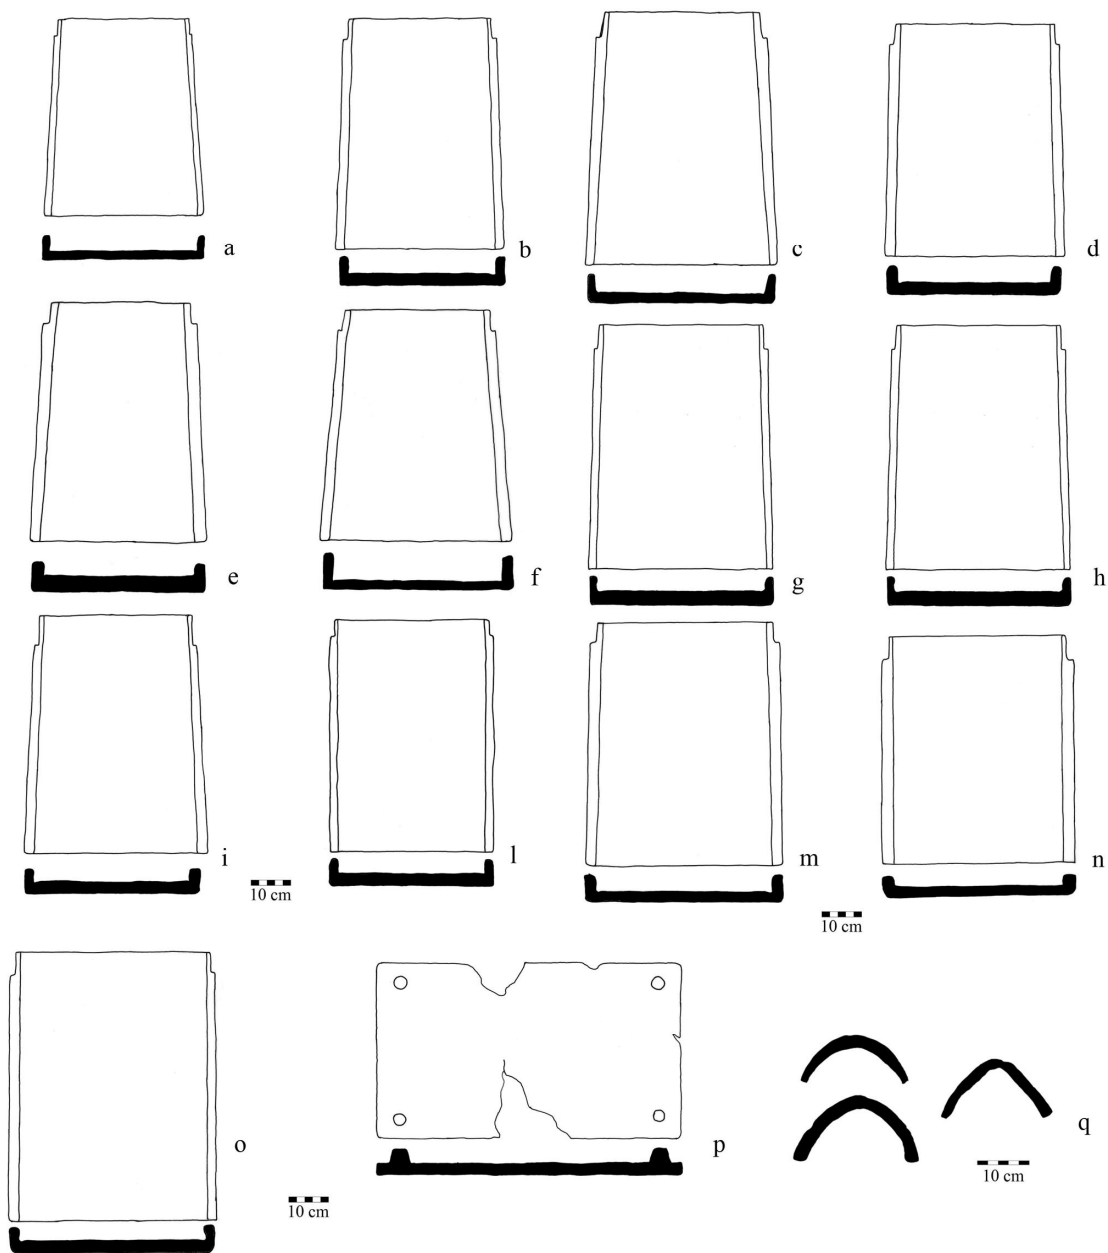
Laterizi (a-m: tegole trapezoidali; n-o: tegole rettangolari; p: tegola mammata; q: coppi).
